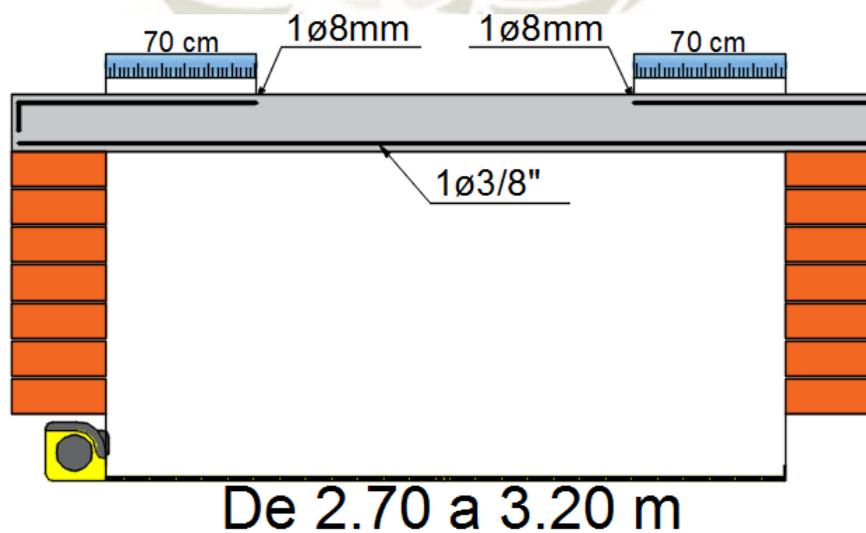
Refuerzo en vigueta hasta 3.20 m.
